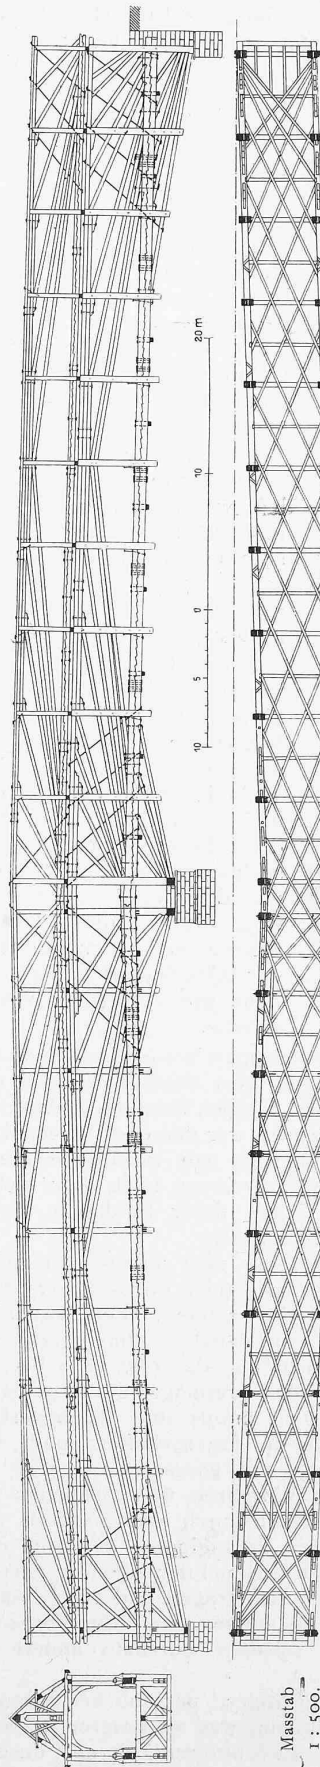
Grundrisse und Schemite der ehemaligen Rheinbrücke zu Schaffhausen. — Nach «Plans, coupes et élévations . . . par J. Ch. Kraft, Architecte-Dessinateur, Paris. An XIII — 1805».
